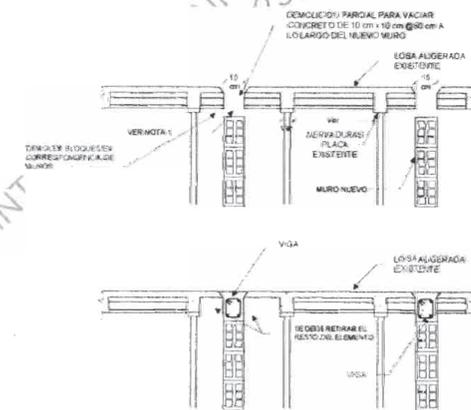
Conexión de muro nuevo a losa existente con nervios. Muro coincidente con los nervios.
